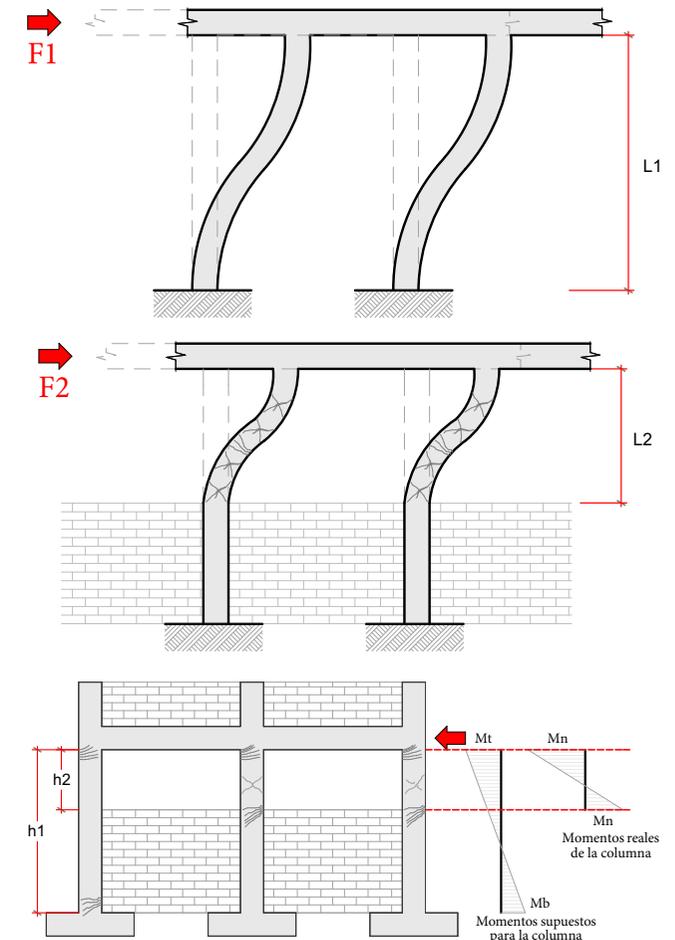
Encuentro entre muros de ladrillo con marco de concreto generando fallas por columna corta
